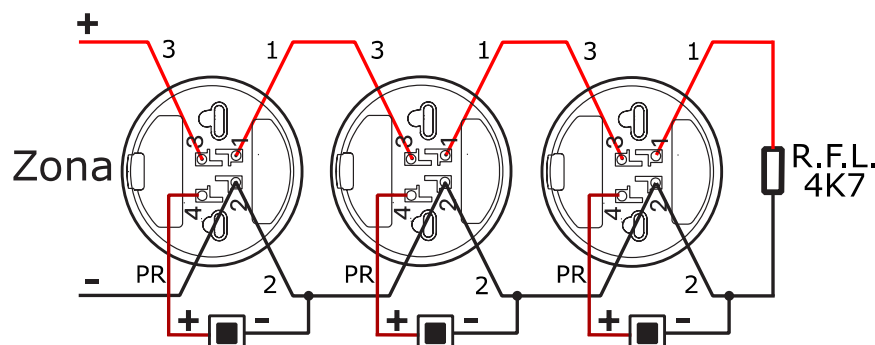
Collegamento dei rivelatori con la spia luminosa di indicazione dell'azione
